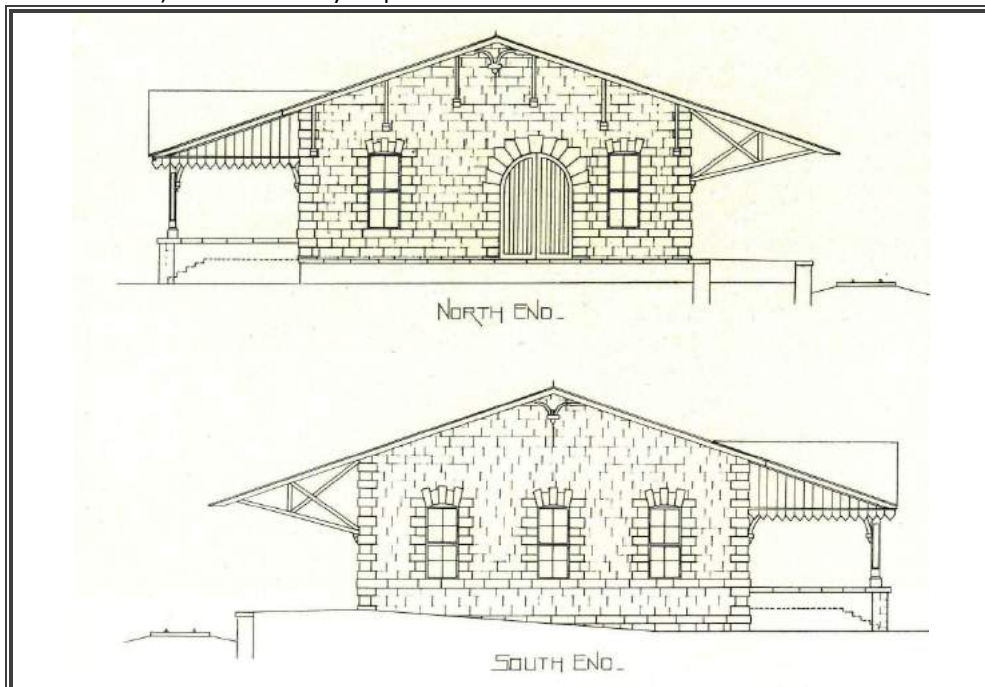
Son un par de dibujos de las fachadas norte y sur. Es de las pocas evidencias que existen de planos de la Estación y seguramente corresponden a un proyecto para la cubierta después del 31 ya que no existe el torreón. Sin embargo no se realizó o bien era una solución "tipo" lo cual era muy frecuente en las obras del ferrocarril, es decir, utilizar un plano y especificaciones como base para construir en distintos sitios. Fuente : SCT, *Caminos de Hierro, México, 1996, p.124
